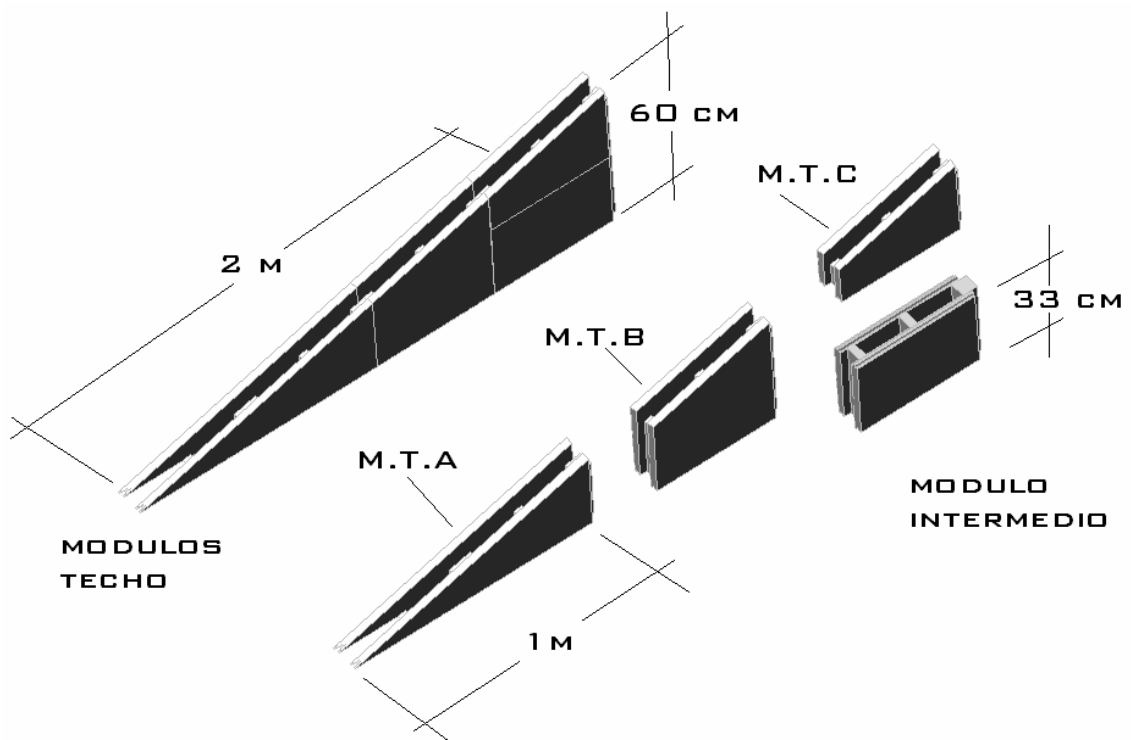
DETALLE ELEMENTOS INCLINADOS DE TECHO
